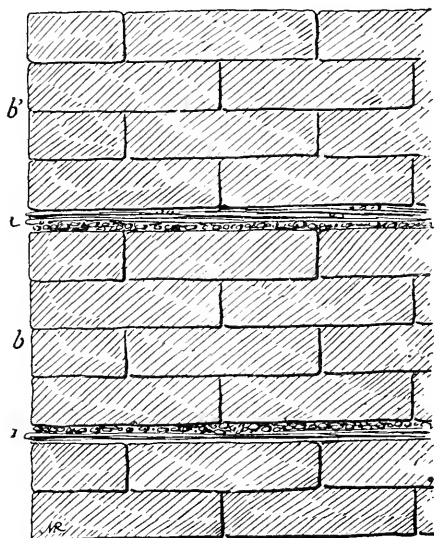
Coupe verticale d'un mur avec lits de roseaux.
